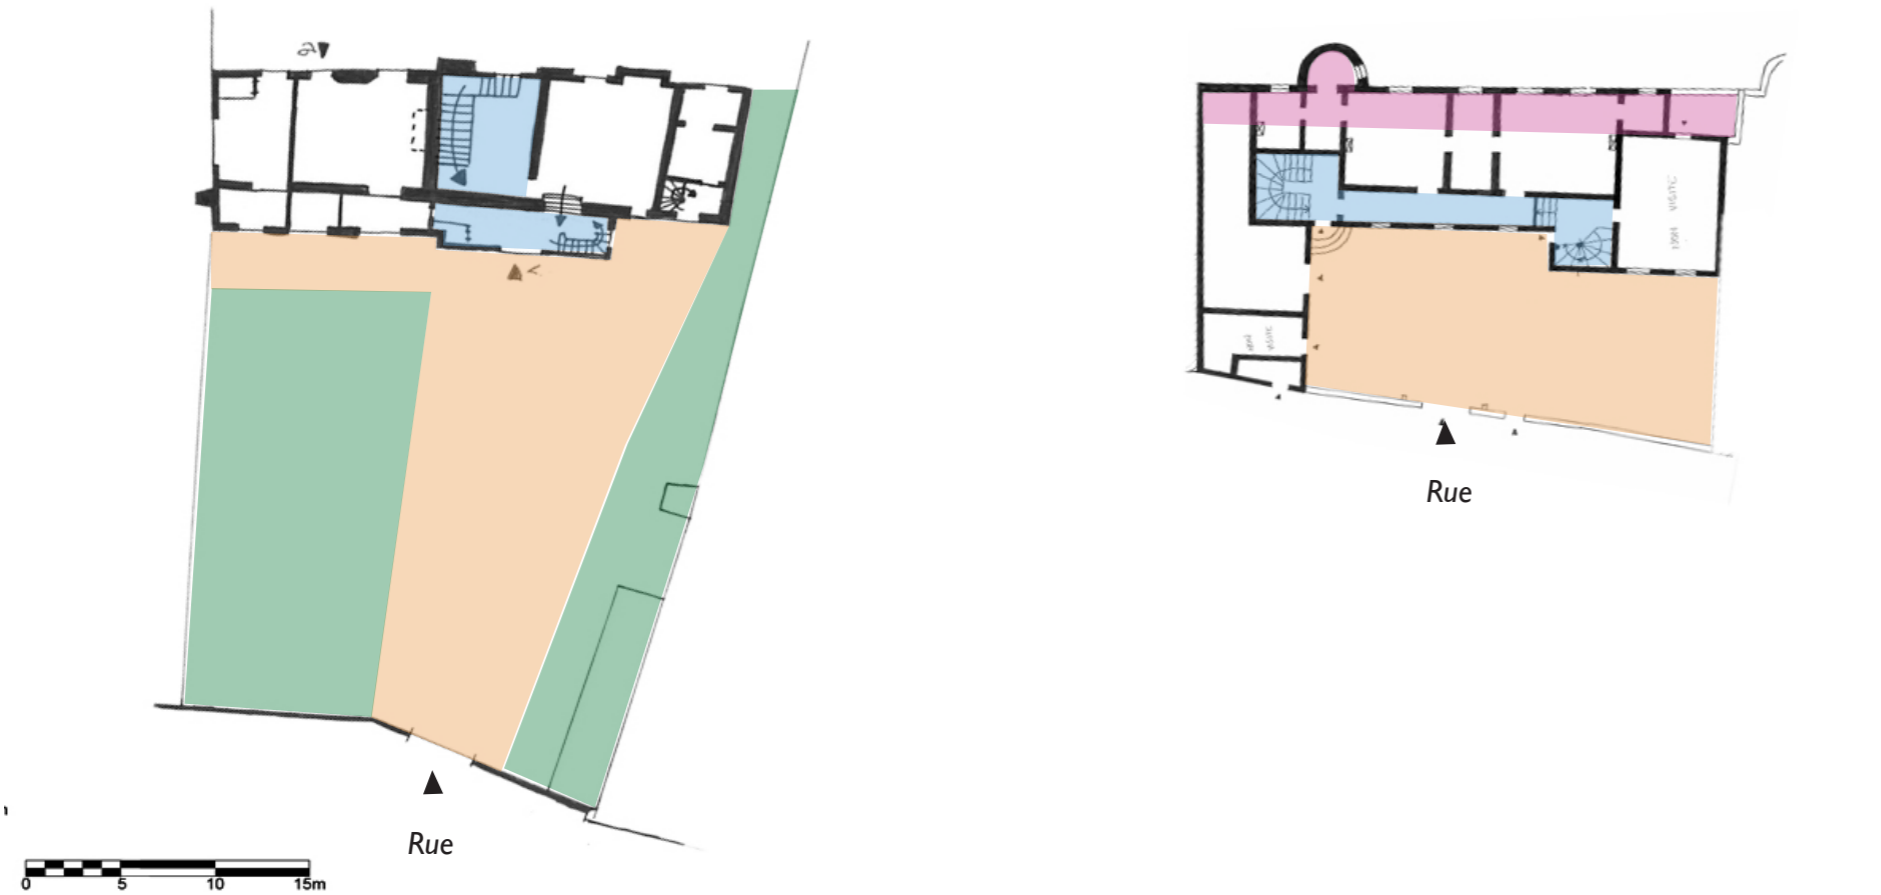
Plans rez-de-chaussée des hôtels particuliers avec une cour d'entrée
